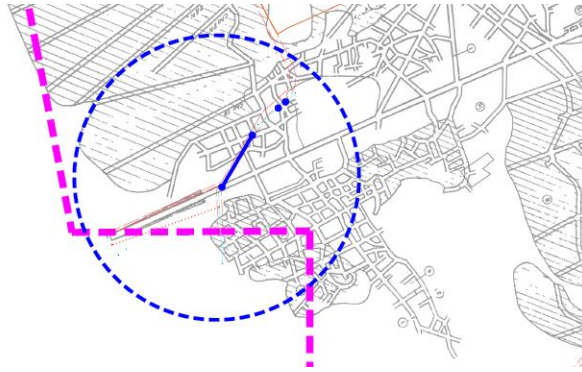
Extrato da sobreposição do P2 com a planta das galerias da mina, na Rua dos Mineiros
